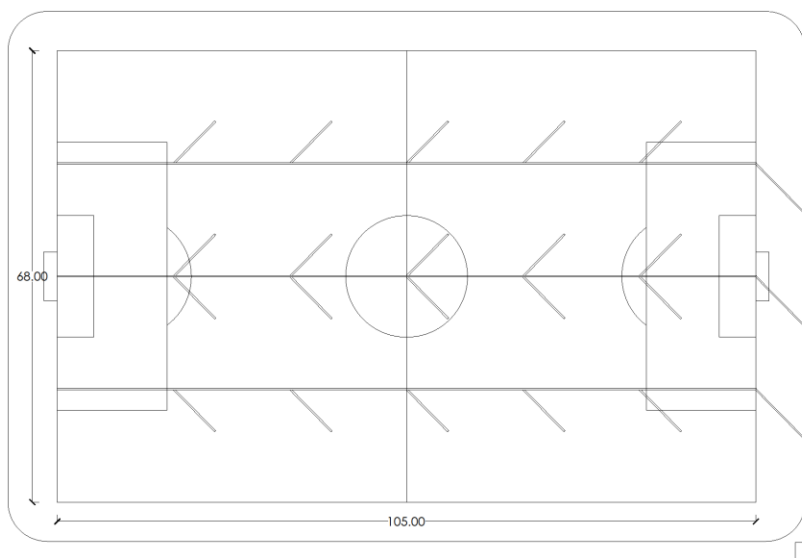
Plano Drenaje Terreno De Juego / Fuente Elaboración Propia
